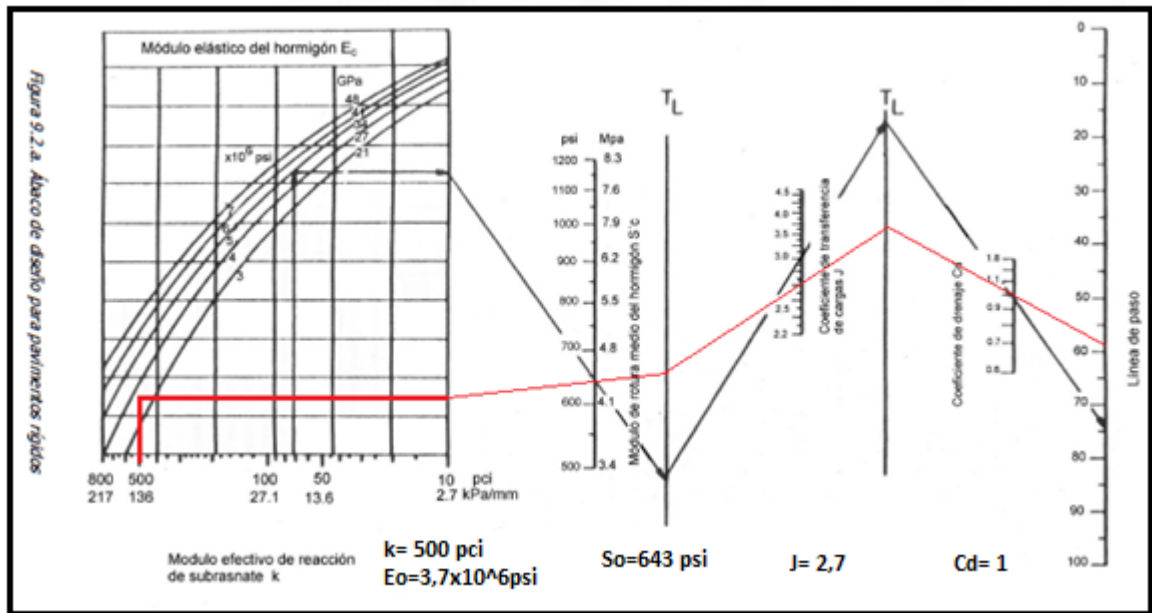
Ábaco de diseño de pavimentos rígidos (Fuente: Guía AASHTO “Diseño de estructuras de pavimentos, 1993”).
